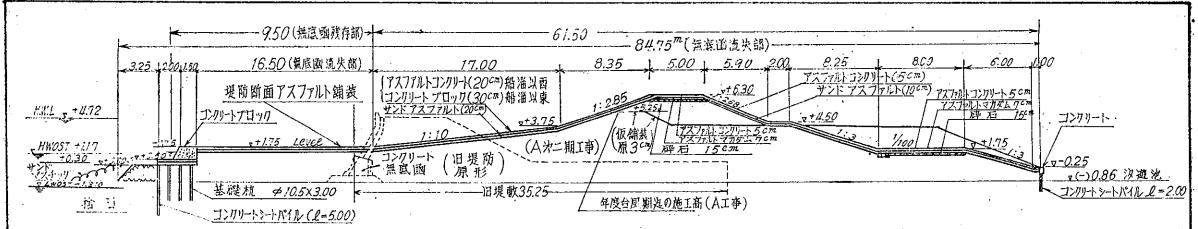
鍋田干拓海岸堤標準断面図 S=1/300
